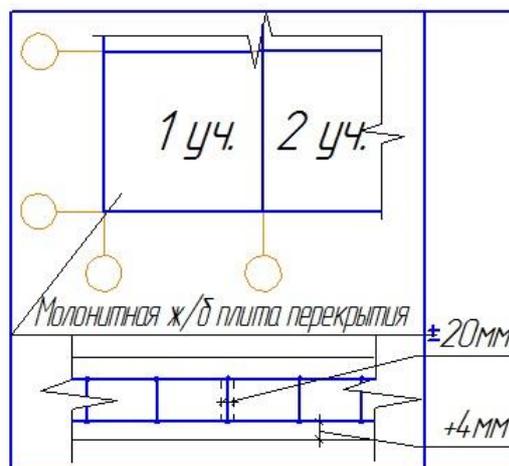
Схема допустимых отклонений при бетонировании плиты перекрытия
